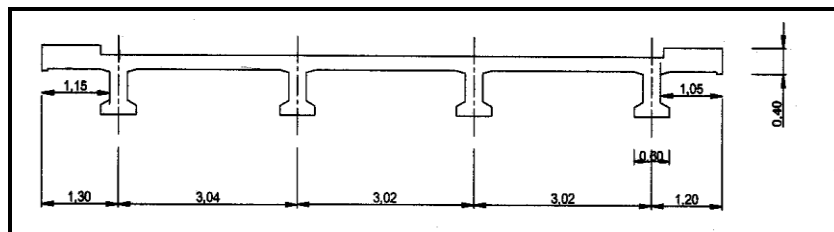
Corte transversal esquemático de la estructura del puente.
